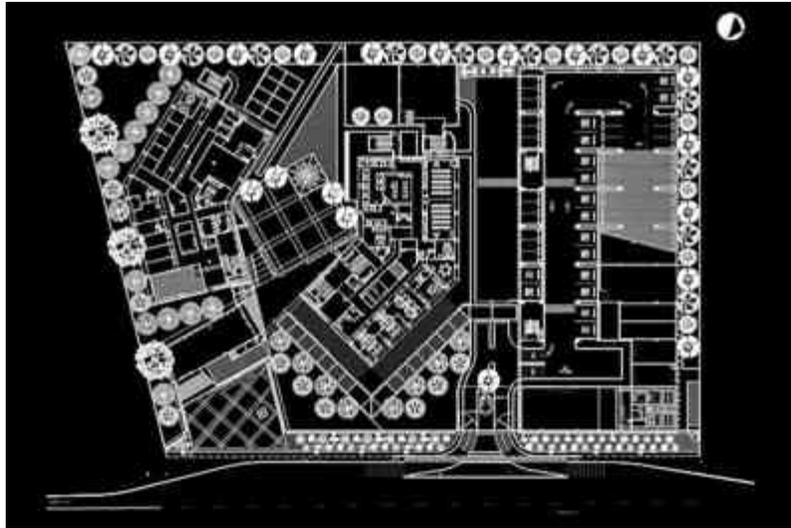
Detalle de planta arquitectónica de conjunto. Fuente: arquitecture.
